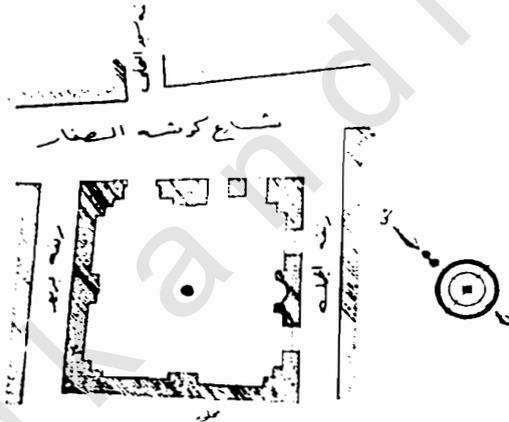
مسقط أفقي لجامع الدباغ عن الموسوعة (الجزء الأول).
